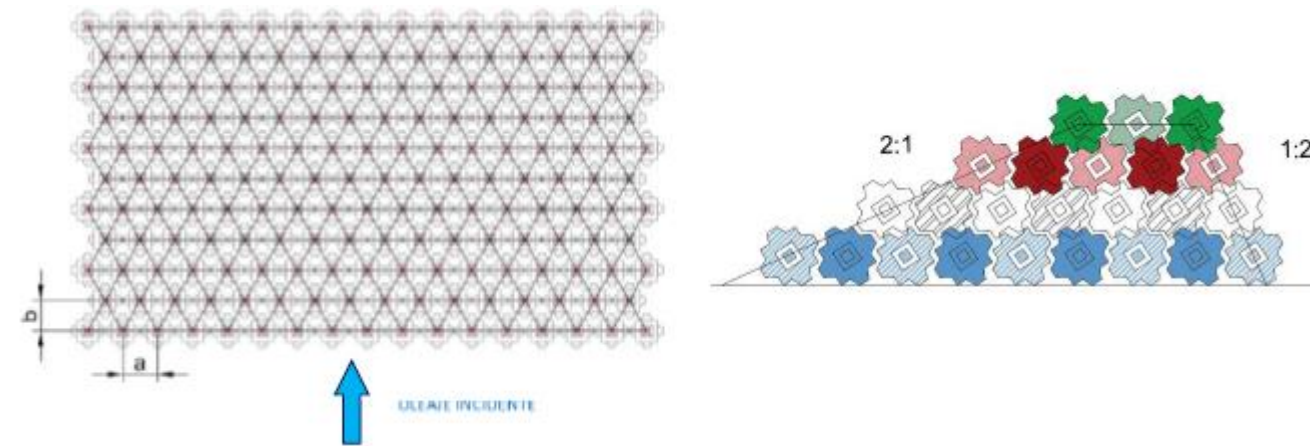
Parámetros de diseño de la malla de colocación y la sección transversal. (Fuente: Lozano Tovar, S., 2021)
